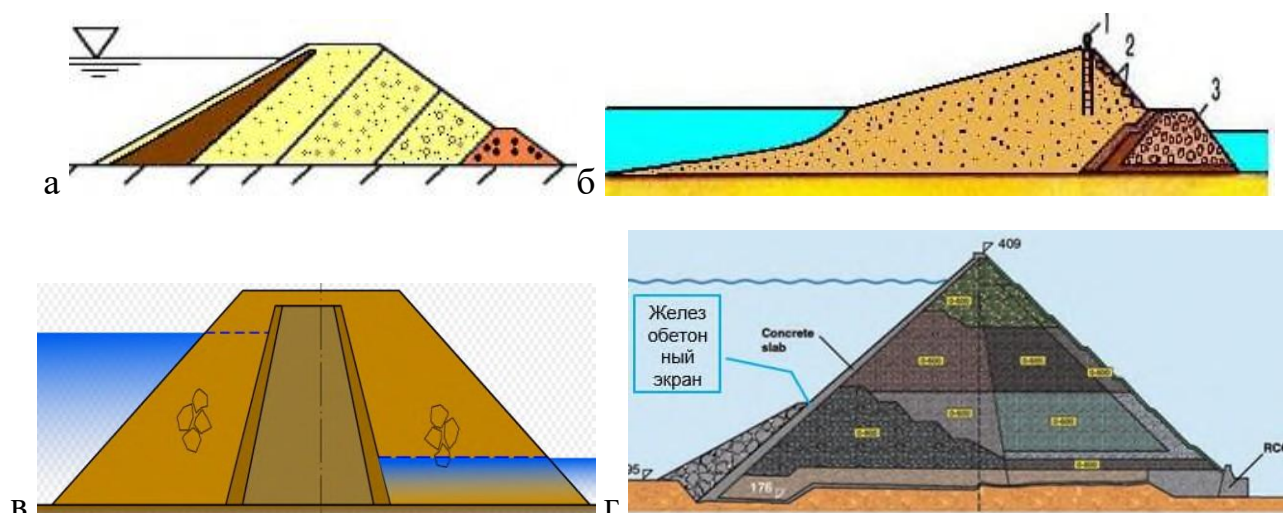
Типы грунтовых плотин/дамб: а – земляная, неоднородная, насыпная с экраном; б – земляная намывная; в – каменно-земляная с центральным грунтовым ядром; г - высоконапорная каменно-набросная плотина Шуйбуйя с железобетонным экраном Нпл = 233 м, Китай
